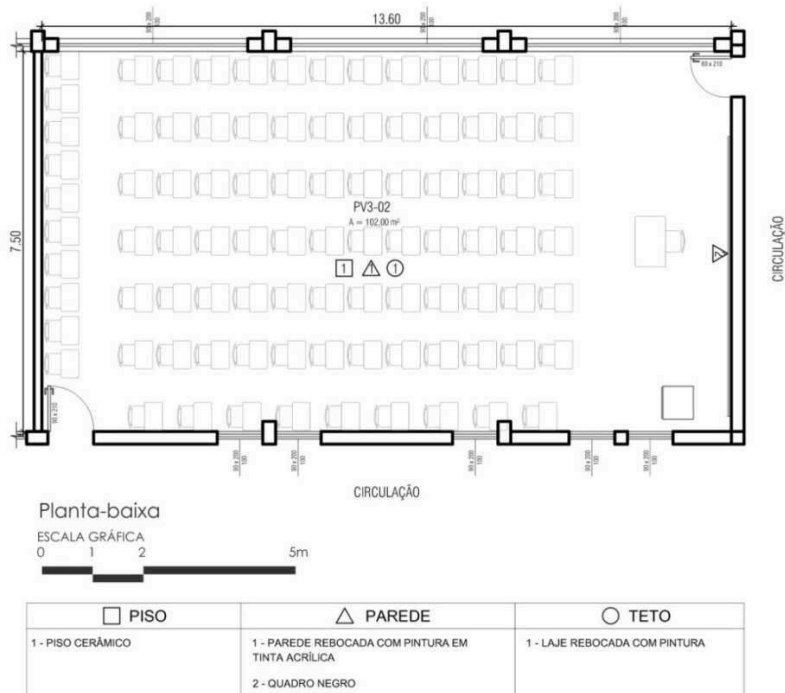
Planta e quadro de acabamentos da Sala PV3-02
